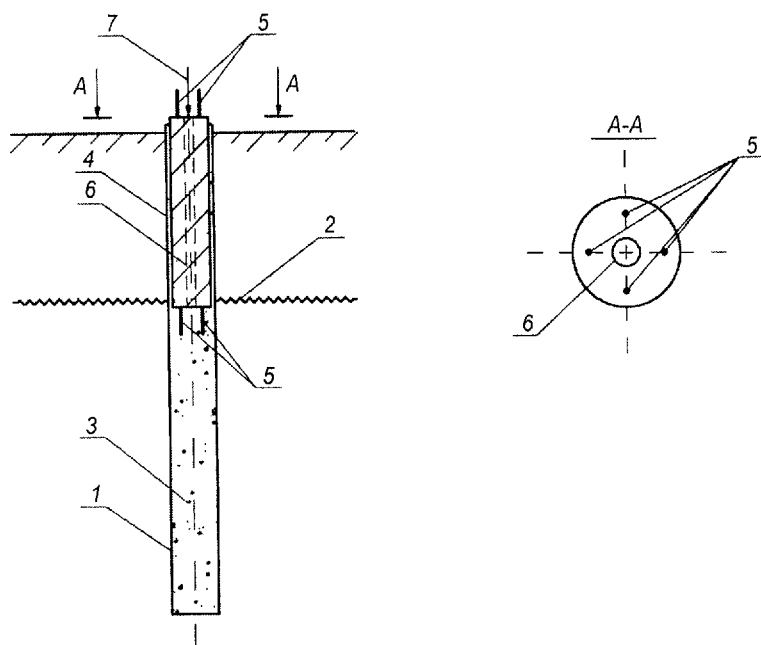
Способ изготовления буронагнетательной сваи в сезоннопромерзающем грунте: 1 – свая; 2 – отметка сезонного промерзания; 3 – цементно-песчаный раствор; 4 – сборный железобетонный элемент; 5 – выпуски арматуры из железобетонного элемента; 6 – отверстие в железобетонном элементе; 7 – вертикальная нагрузка
